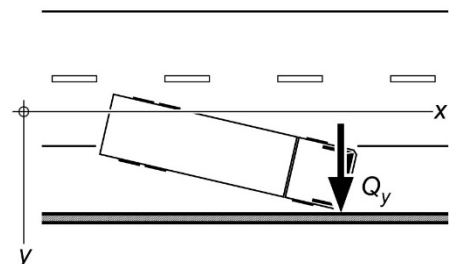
Übersicht Anprall von Fahrzeugen (Fahrzeugchassis)
